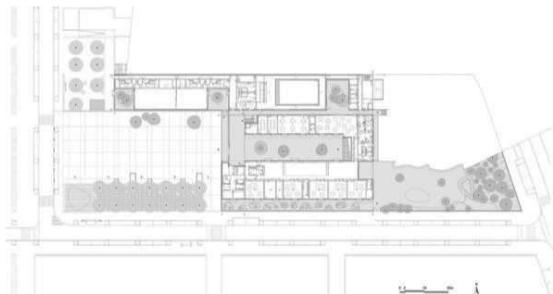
Plan du RDC du groupe scolaire Paul Cézanne
